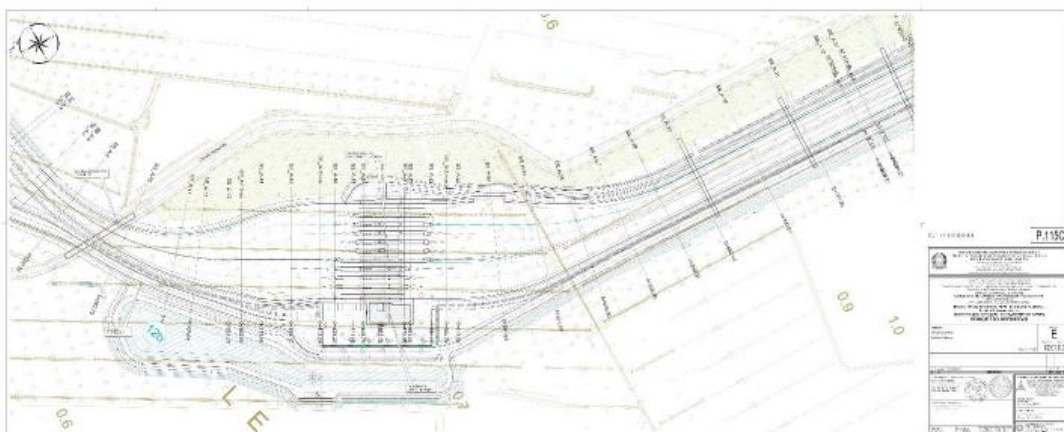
Estratto dalla planimetria tecnica del piazzale di stazione (elab. E.02.01.0.0)
